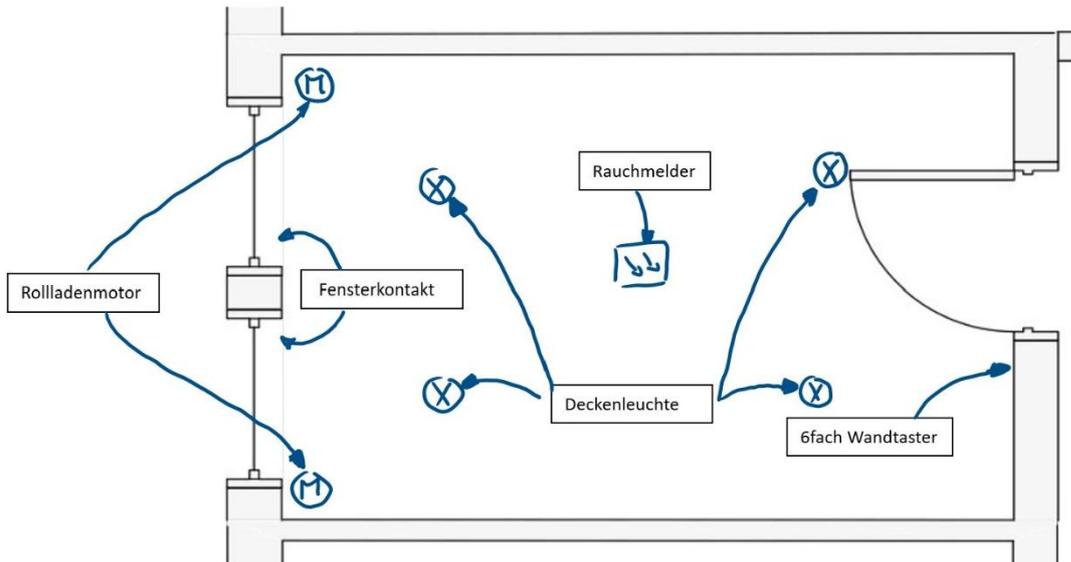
Grundriss Arbeitszimmer mit Geräten
